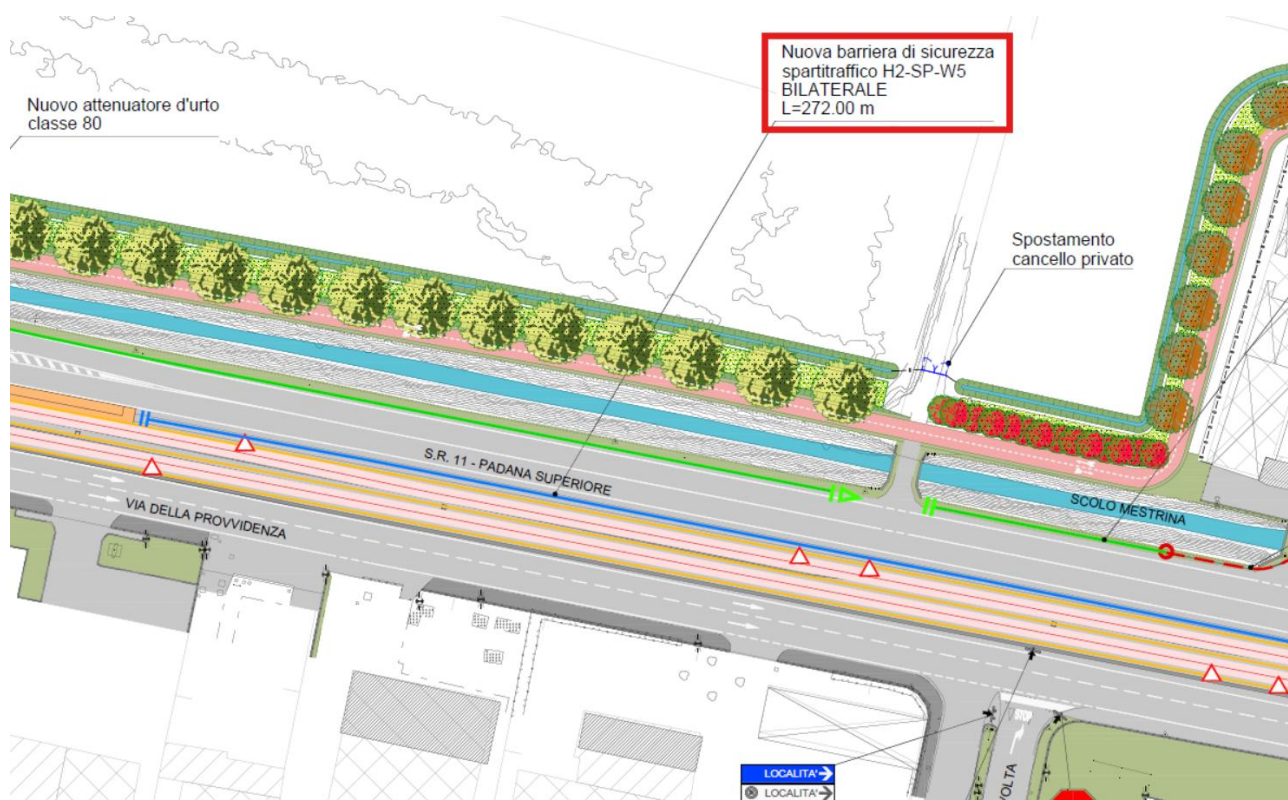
Ubicazione nel tracciato planimetrico di progetto esecutivo di barriera di sicurezza H2 spartitraffico infissa nel terreno, oggetto di proposta di sostituzione – tratto Est L = 272m ca.
